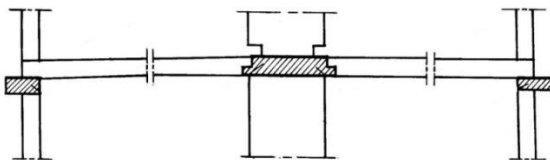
Конструктивная схема сборного каркаса с плоскими перекрытиями
